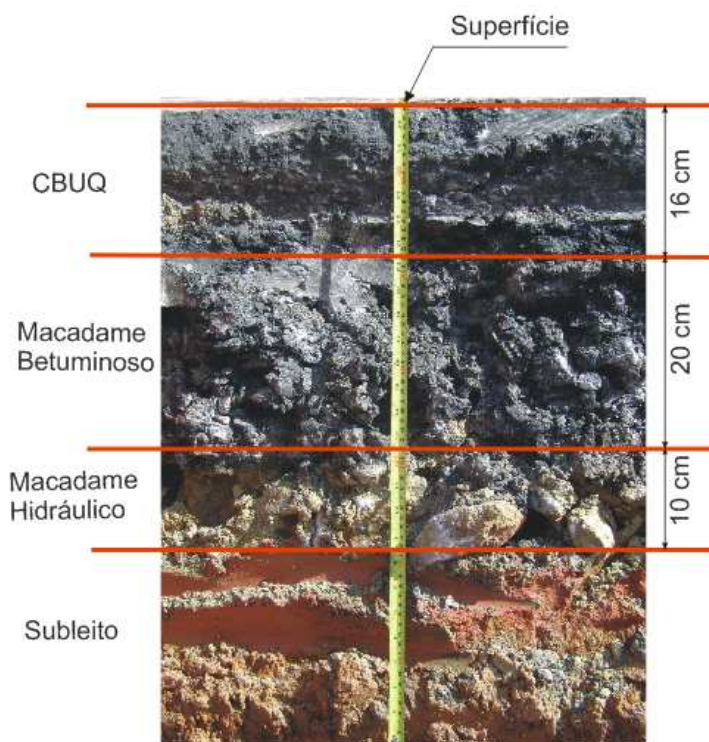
Perfil construtivo da faixa 2, Via DUTRA, Pista Sul, km 239+760, extraído a 1 m do início da reconstrução.
